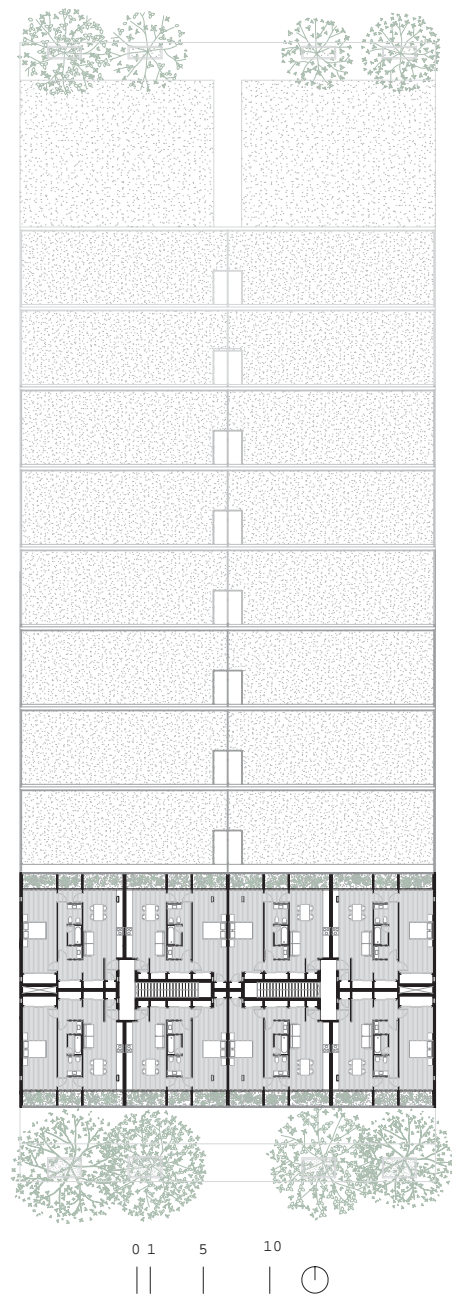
Planta cota 13,30m del módulo de viviendas de un bloc
